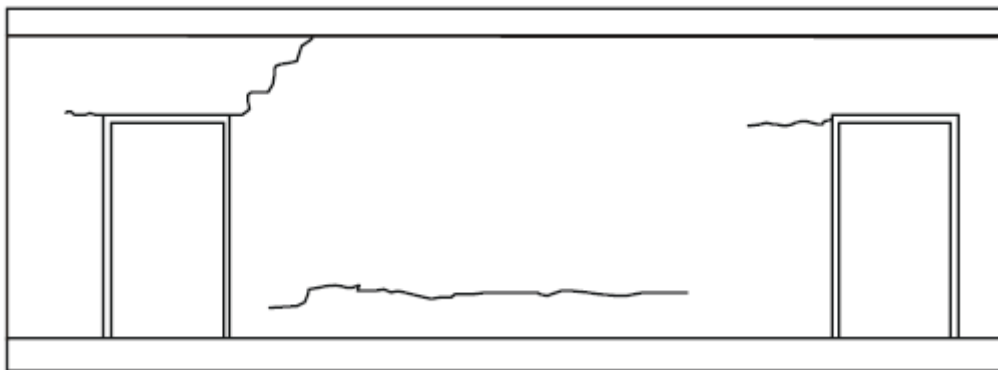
Trincas em parede de vedação: deformação do suporte idêntica a deformação da viga superior.
